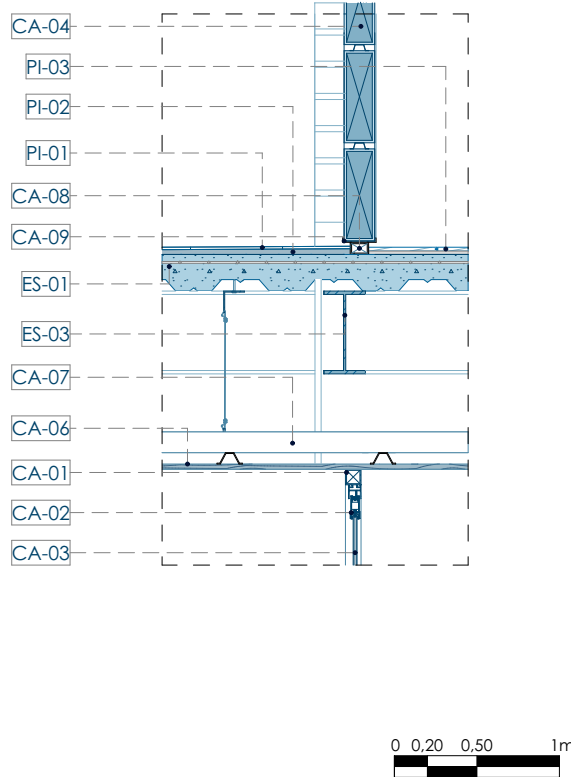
Detalle constructivo 04. Nota. Elaboración propia.
